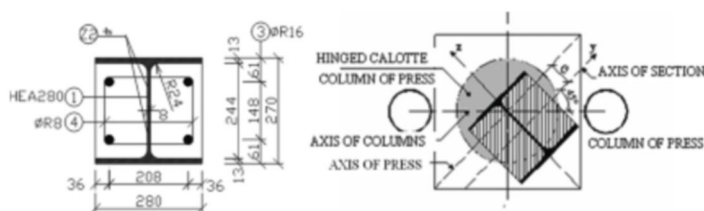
Esquema da secção e dispositivo de ensaio.
